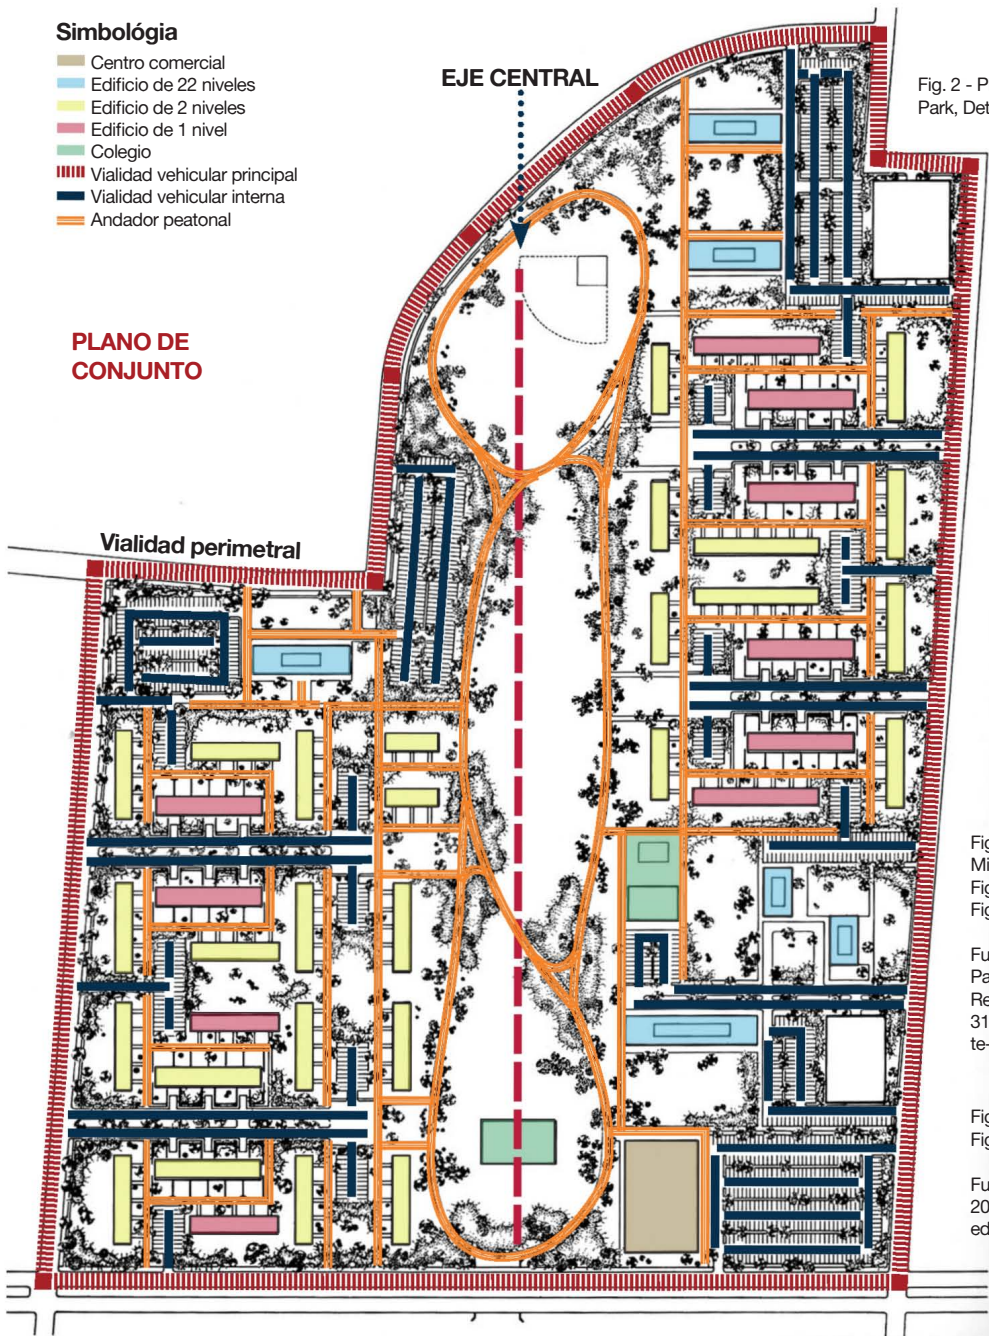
Plano de conjunto de Lafayette Park, Detroit, Michigan, EEUUAA.
